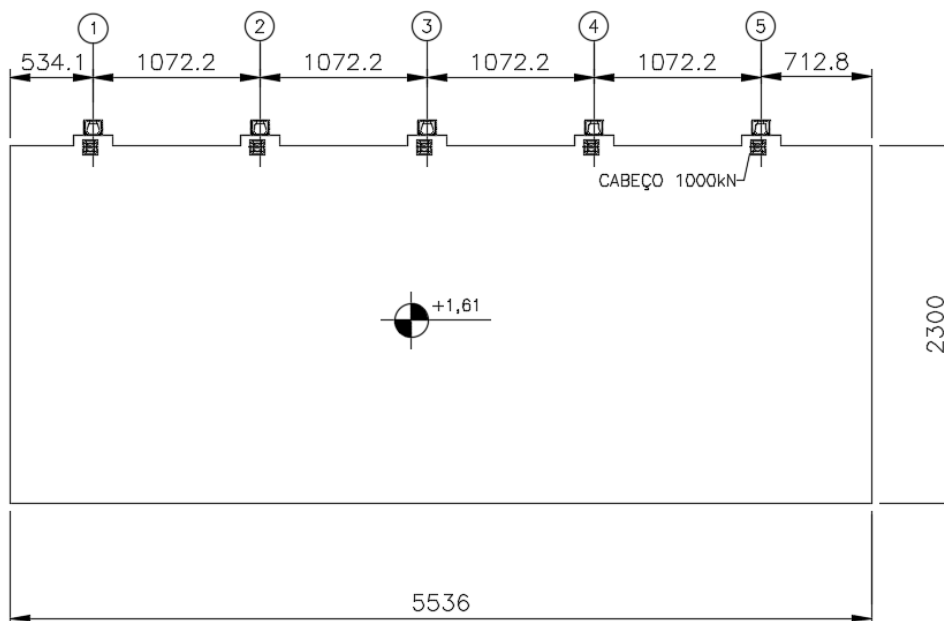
Vista superior da estrutura. Dimensões em cm.
